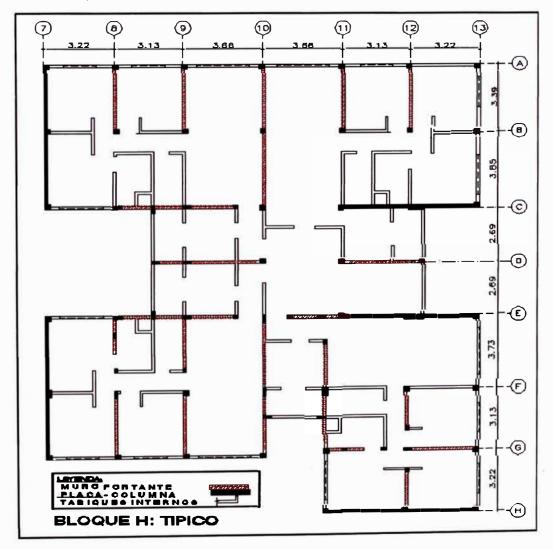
Esquema en planta de los elementos estructurales verticales de un bloque
